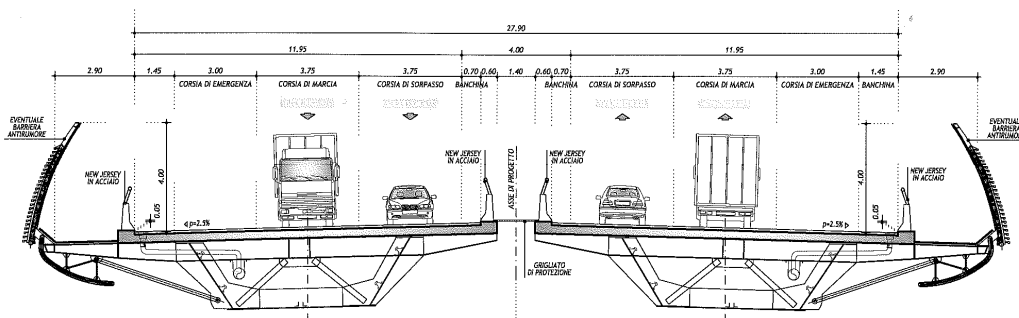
SEZIONE TIPO SU VIADOTTO
